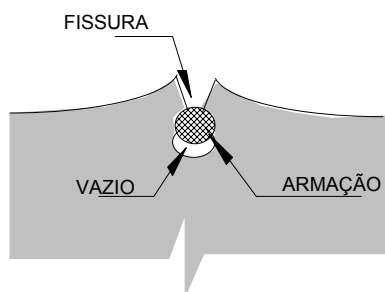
Detalhe da fissura ao longo da armadura
